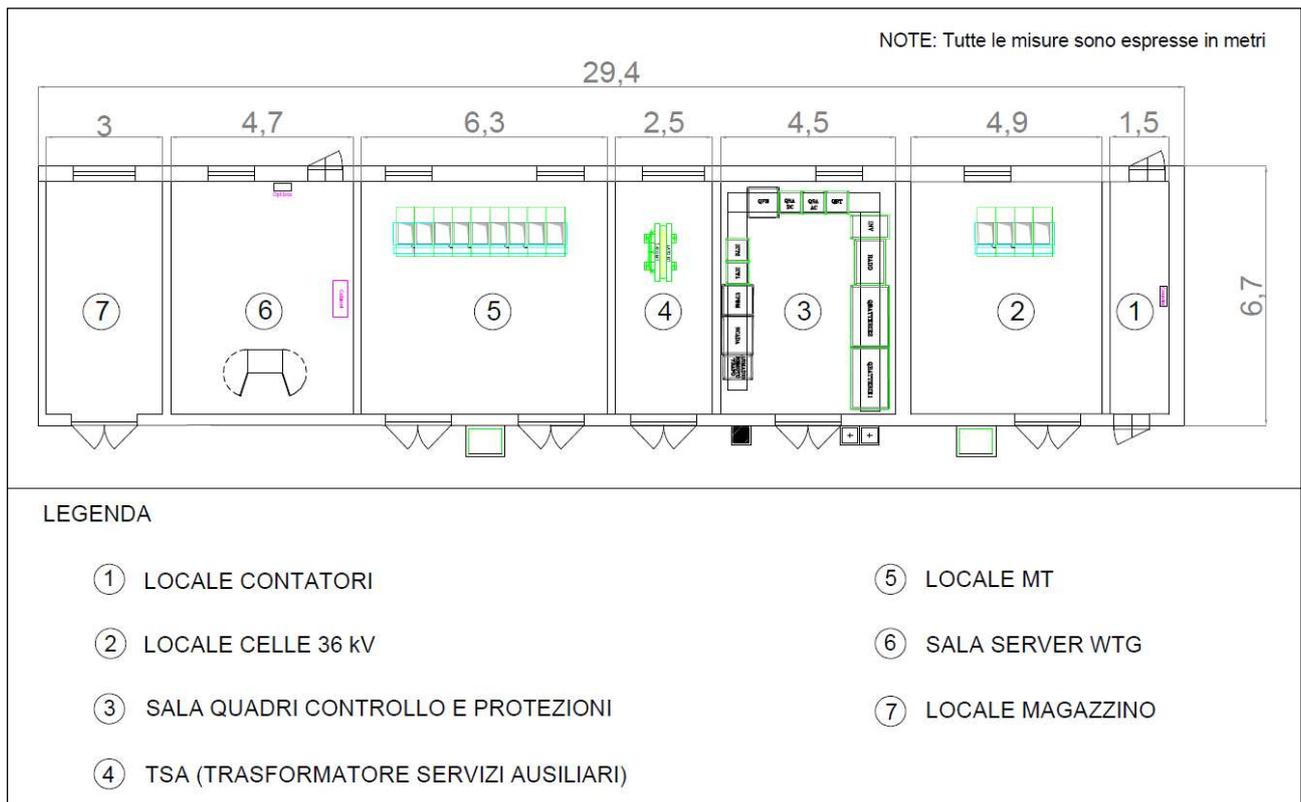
Pianta edificio di controllo SEU 36/33 kV
